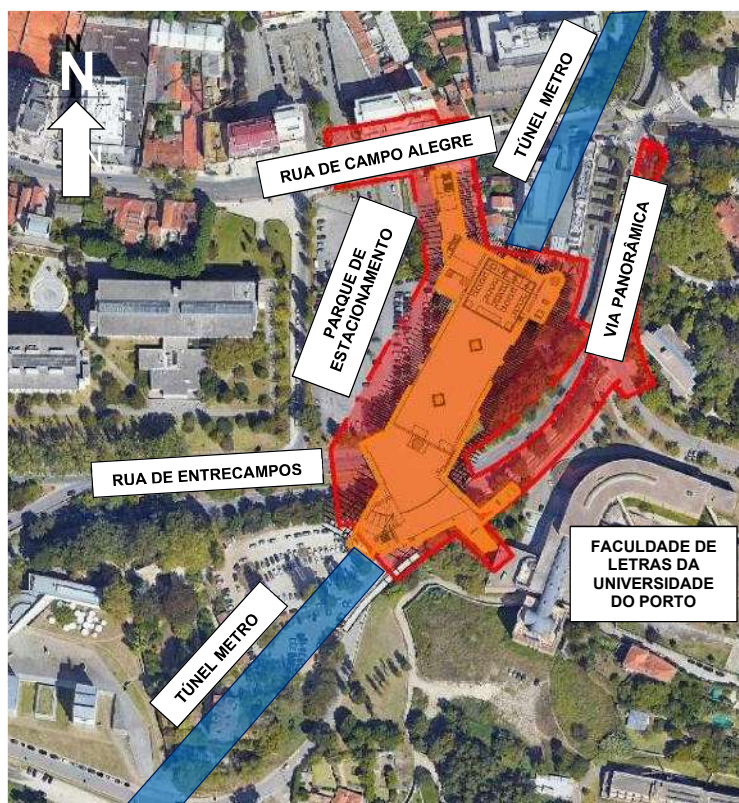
Localização da estação de Campo Alegre (a laranja) e área de implantação (a vermelho).
